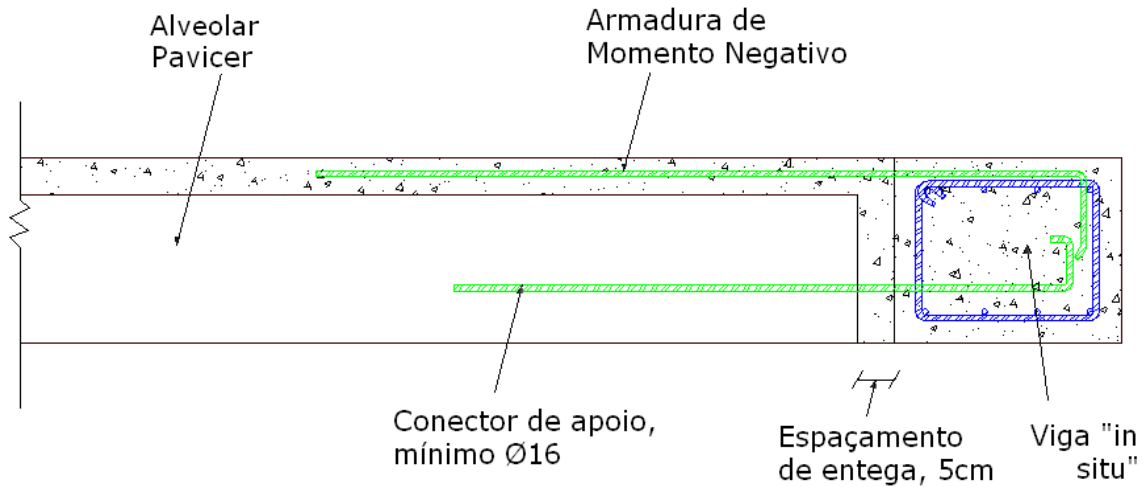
Pormenor tipo de apoio em viga de extremidade embutida.
